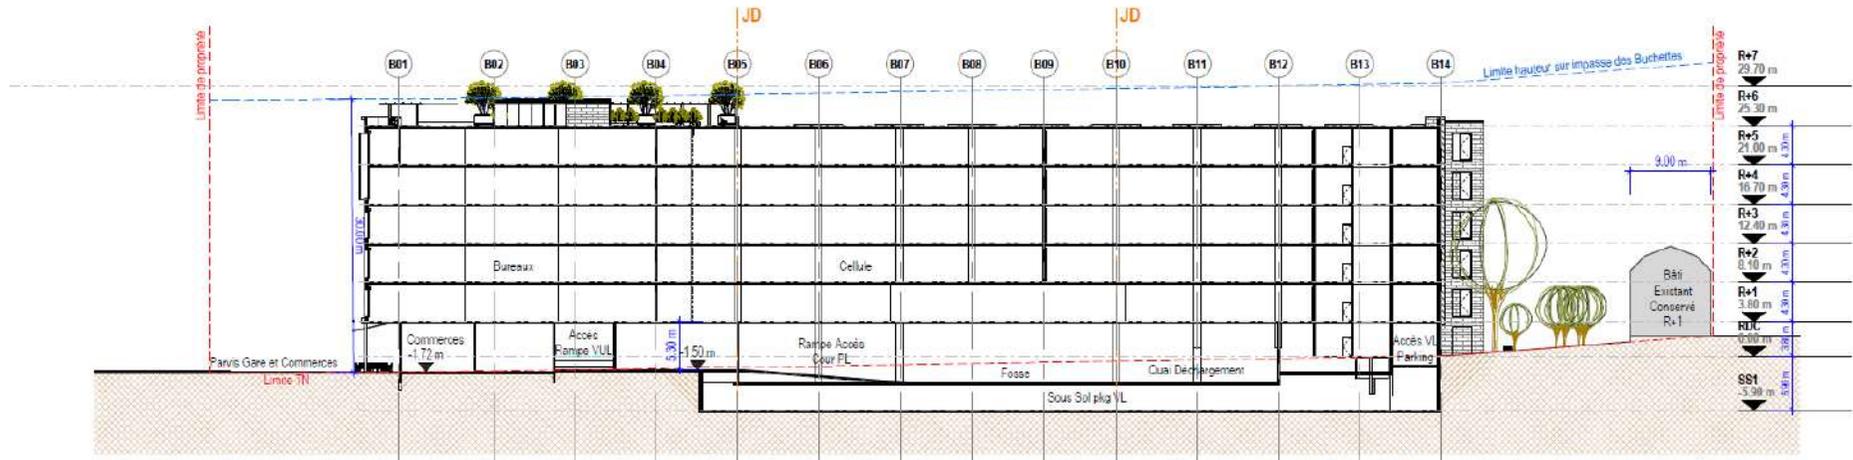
Plan de perspective du bâtiment -Vue Sud (source : SOHO ATLAS IN FINE)
